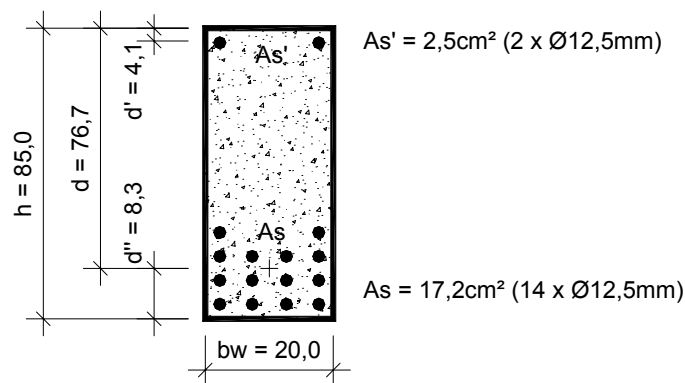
ELU – Seção transversal de concreto armado com armaduras passivas de tração e compressão
